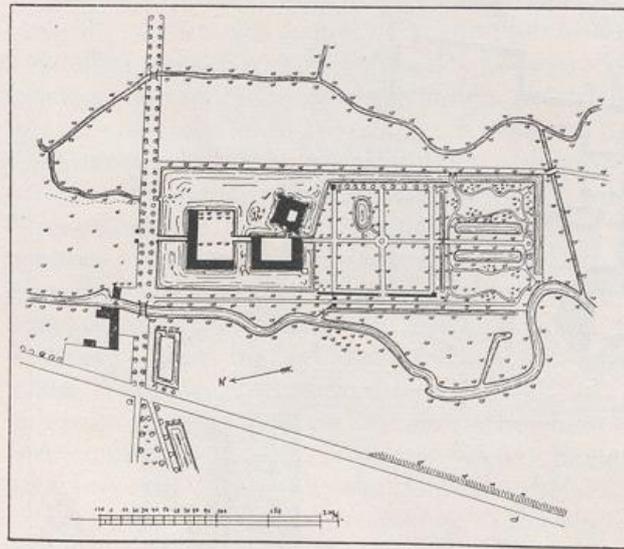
Schloß Trips bei Geilenkirchen, Lageplan.
